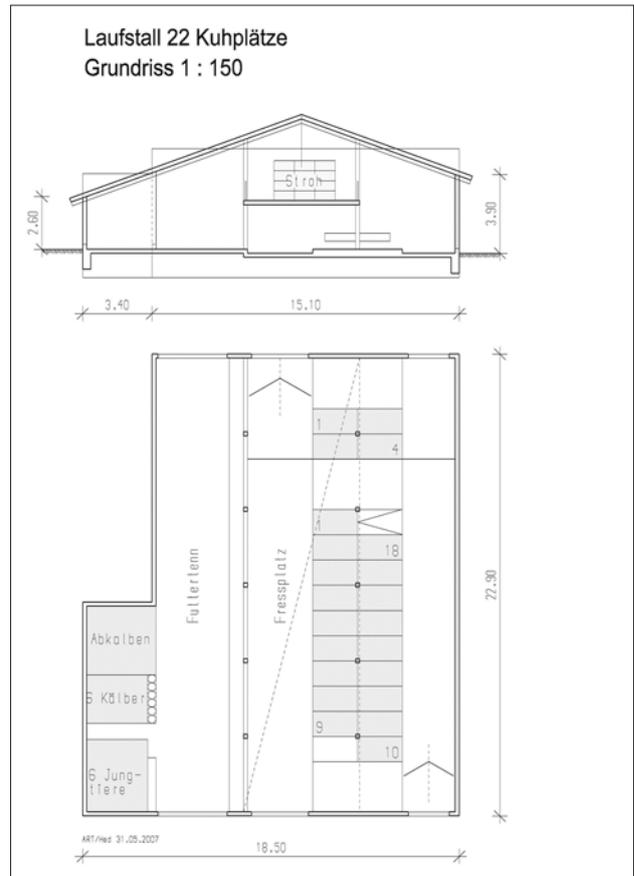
Grundriss und Querschnitt durch die Bauhülle für das Modell Boxenlaufstall (DUX et al., 2009). Die Abbildung zeigt die konzeptionelle Vorstellung einer Gebäudehülle für einen Boxenlaufstall mit 22 Liegeplätzen. Alle Bewegungs- und Managementbereiche sowie der für die Remontierung notwendige Abkalbungs-, Kälber- und Aufzuchtbereich sind integriert.
